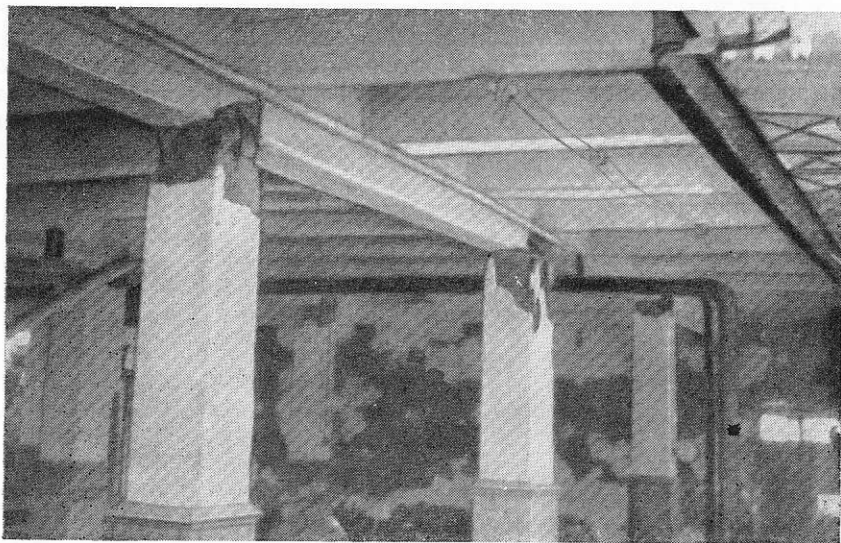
Раздробление бетона в местах сопряжения колонн с ригелями
